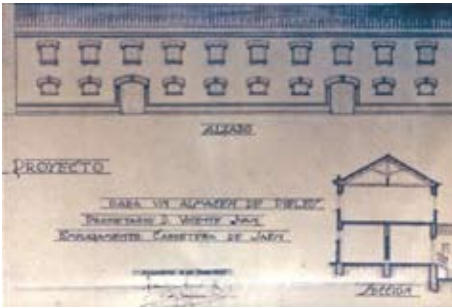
Alzado y sección Carretera de Jaén, 1925.
